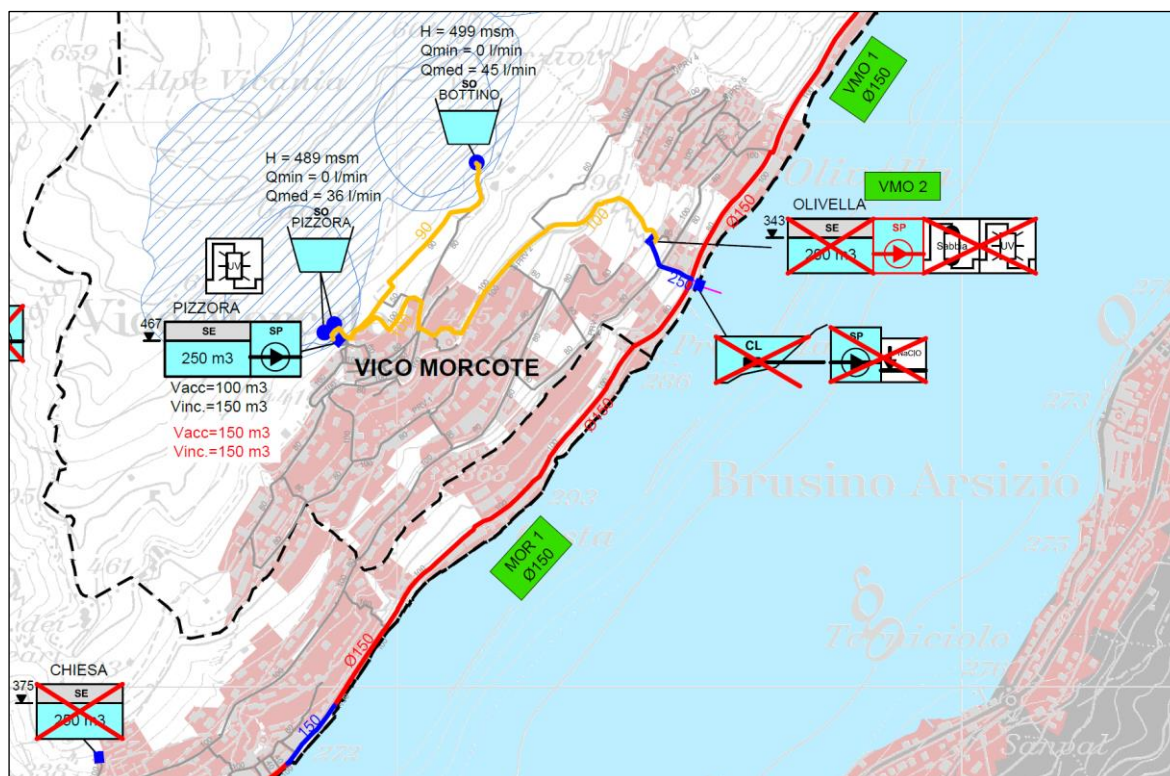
estratto PCAI Collina d'oro, planimetria situazione futura aggiornata al 27.10.2020
